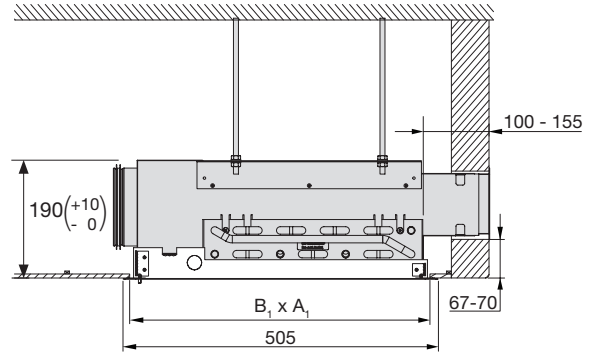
Tilluftsfrontplade -01/-21, dimensioner.
